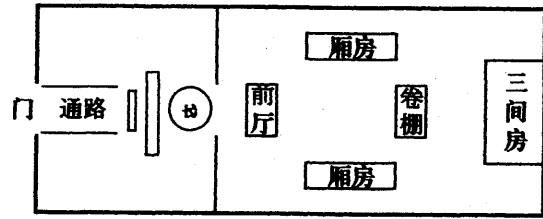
西门慶祖(墓地)平面図 出典：[16, p. 189]
